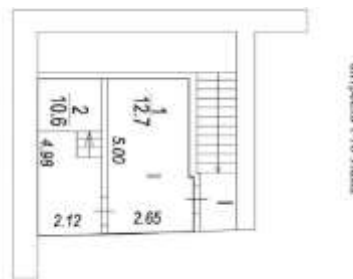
Схема оцениваемых помещений на поэтажных планах (антресоль 1 этажа)
